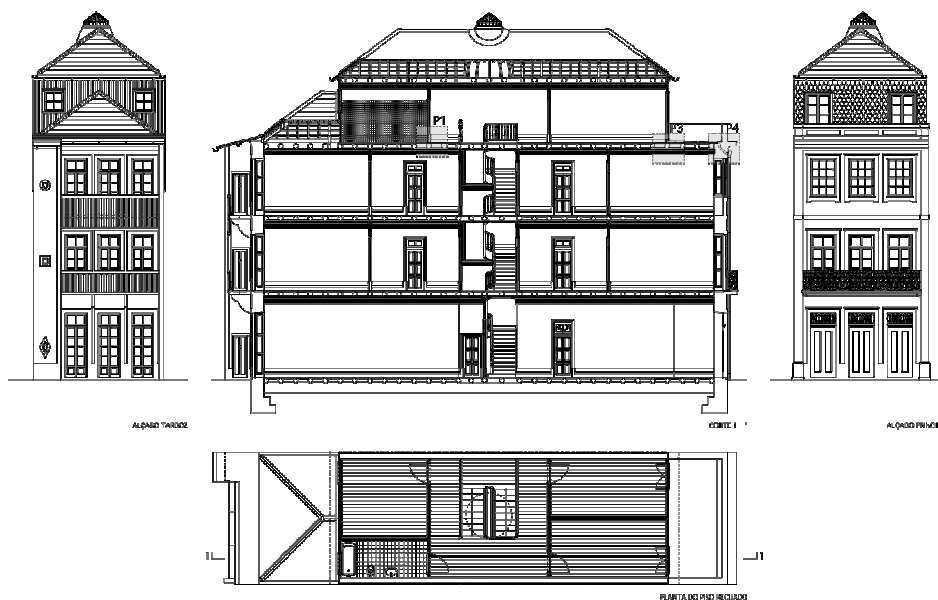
Modelo construtivo das casas burguesas do Porto - planta do piso recuado, corte longitudinal e alçados da rua e de tardoz.
